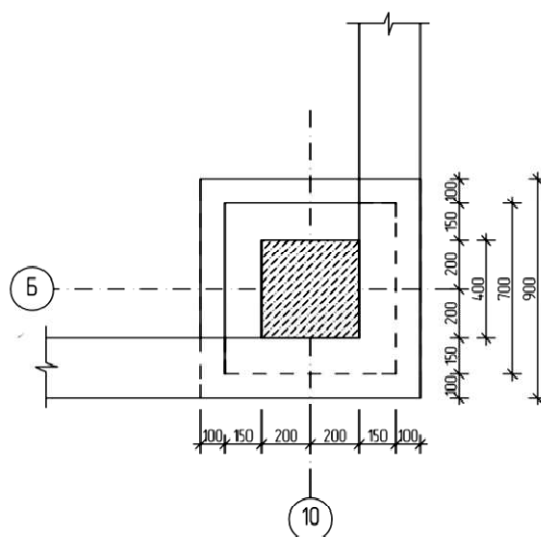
Схема столбчатого фундамента Ф-3, вид сверху.
